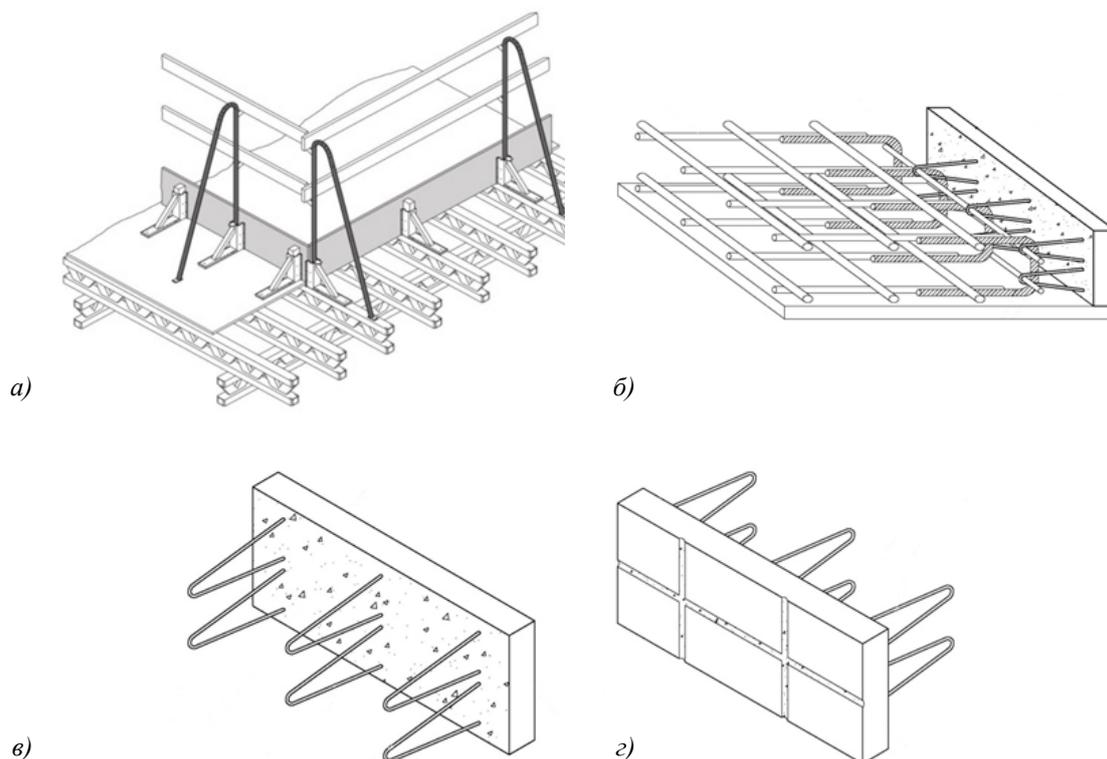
Конструктивные решения для формирования торцов монолитных плит перекрытия: а) съемная опалубка торцов; б) соединение несъемной железобетонной опалубки с арматурным каркасом перекрытия; в) и г) общий вид элемента несъемной железобетонной опалубки перекрытия
